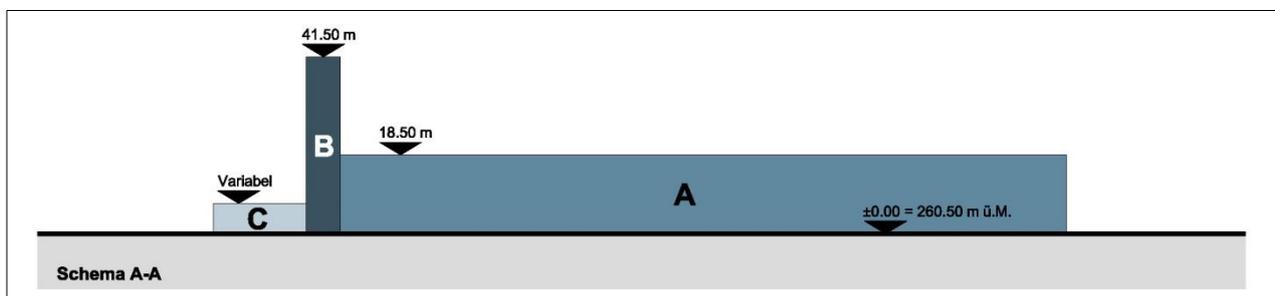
Plan Nr. 13'998, Neuer Bebauungsplan: Schnitt (kein Massstab)
